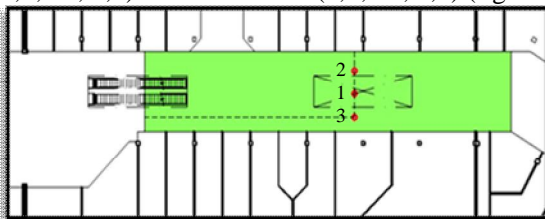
Locação dos pontos de medição no primeiro pavimento (área A3).
